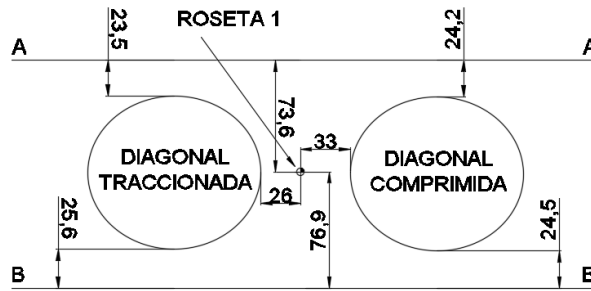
Ubicación de roseta sobre la brida, vista de planta. (mm)
